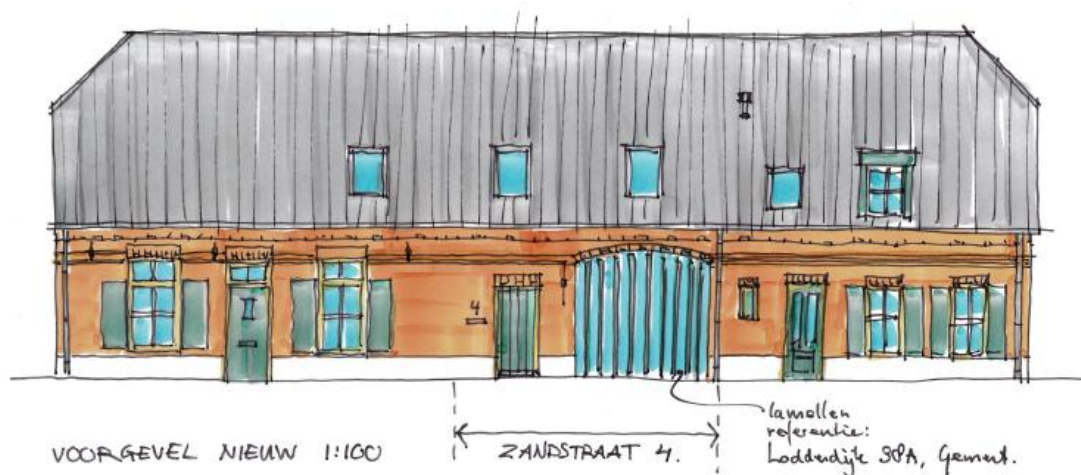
Inrichtingsplan ruimtelijke kwaliteitsverbetering Zandstraat 4
